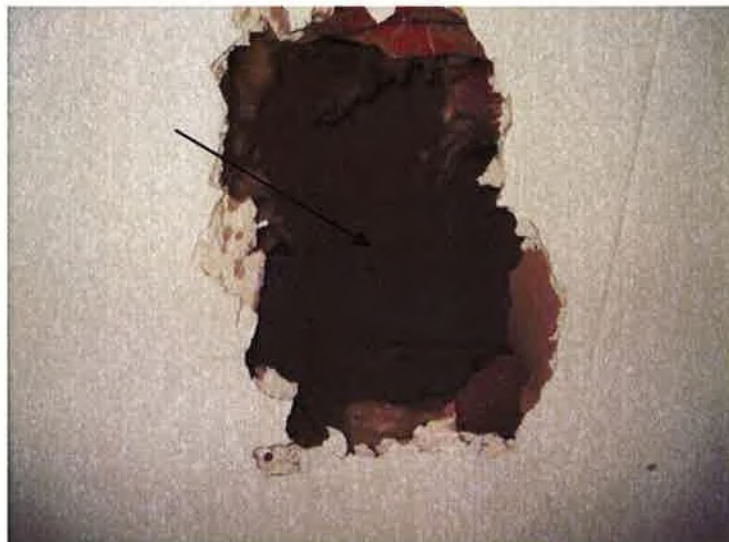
asbestvrij dakbeschot tegen het dak van slaapkamer 1 van Laurentiusstraat 88.
